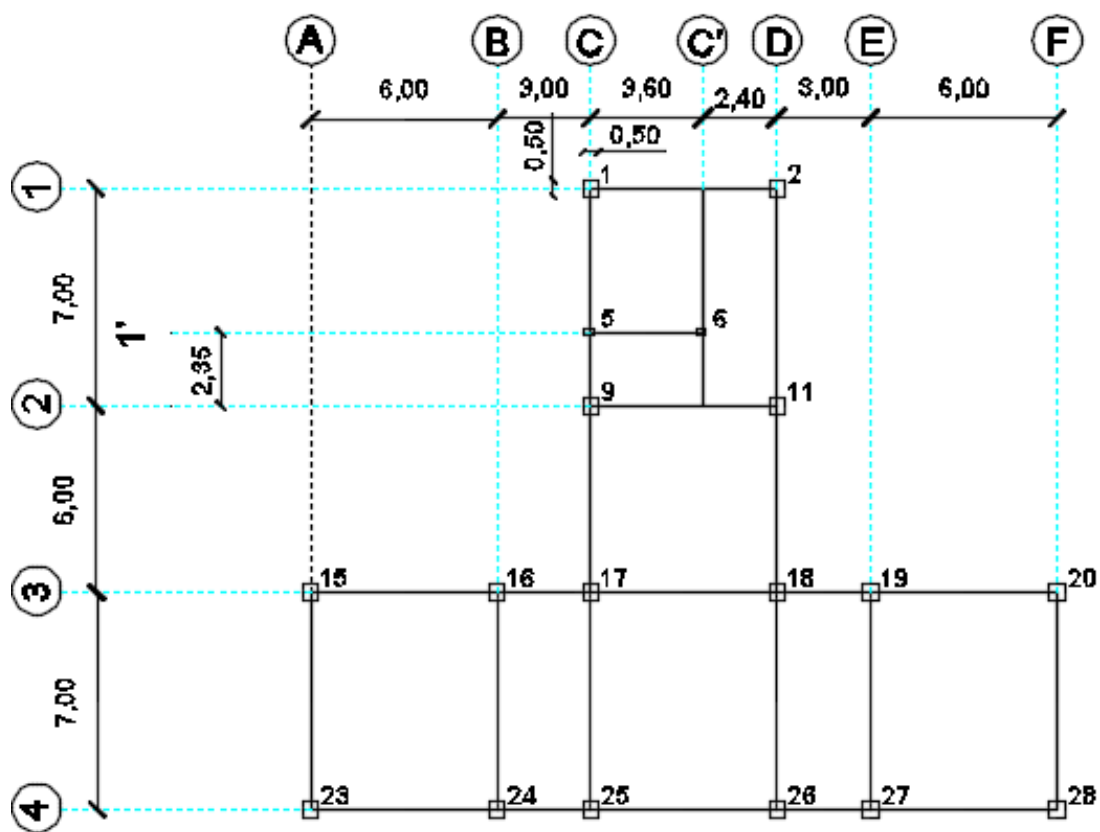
, Esquema planta primer piso, Edf Bco. Central, Manta, Jipijapa, unidades (m).
